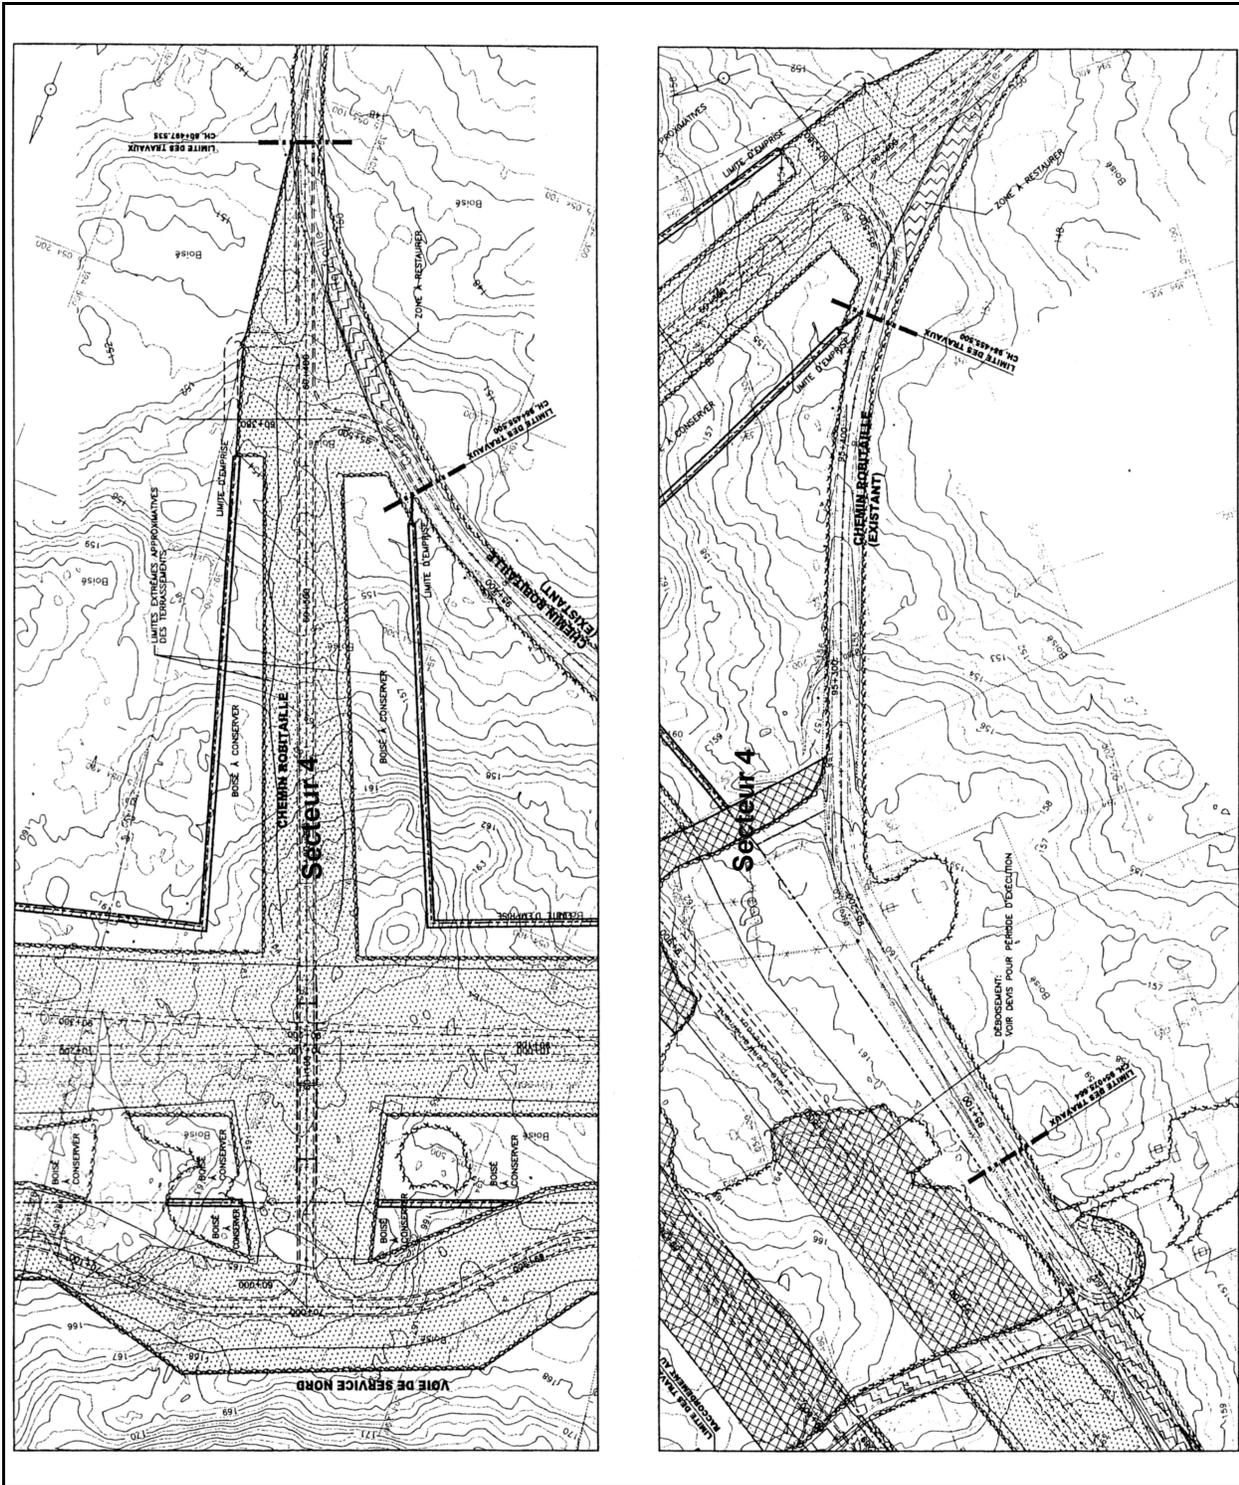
Localisation des secteurs d'inventaire sur le plan de construction du projet 20-6671-9509, autoroute 50 (5/8)
